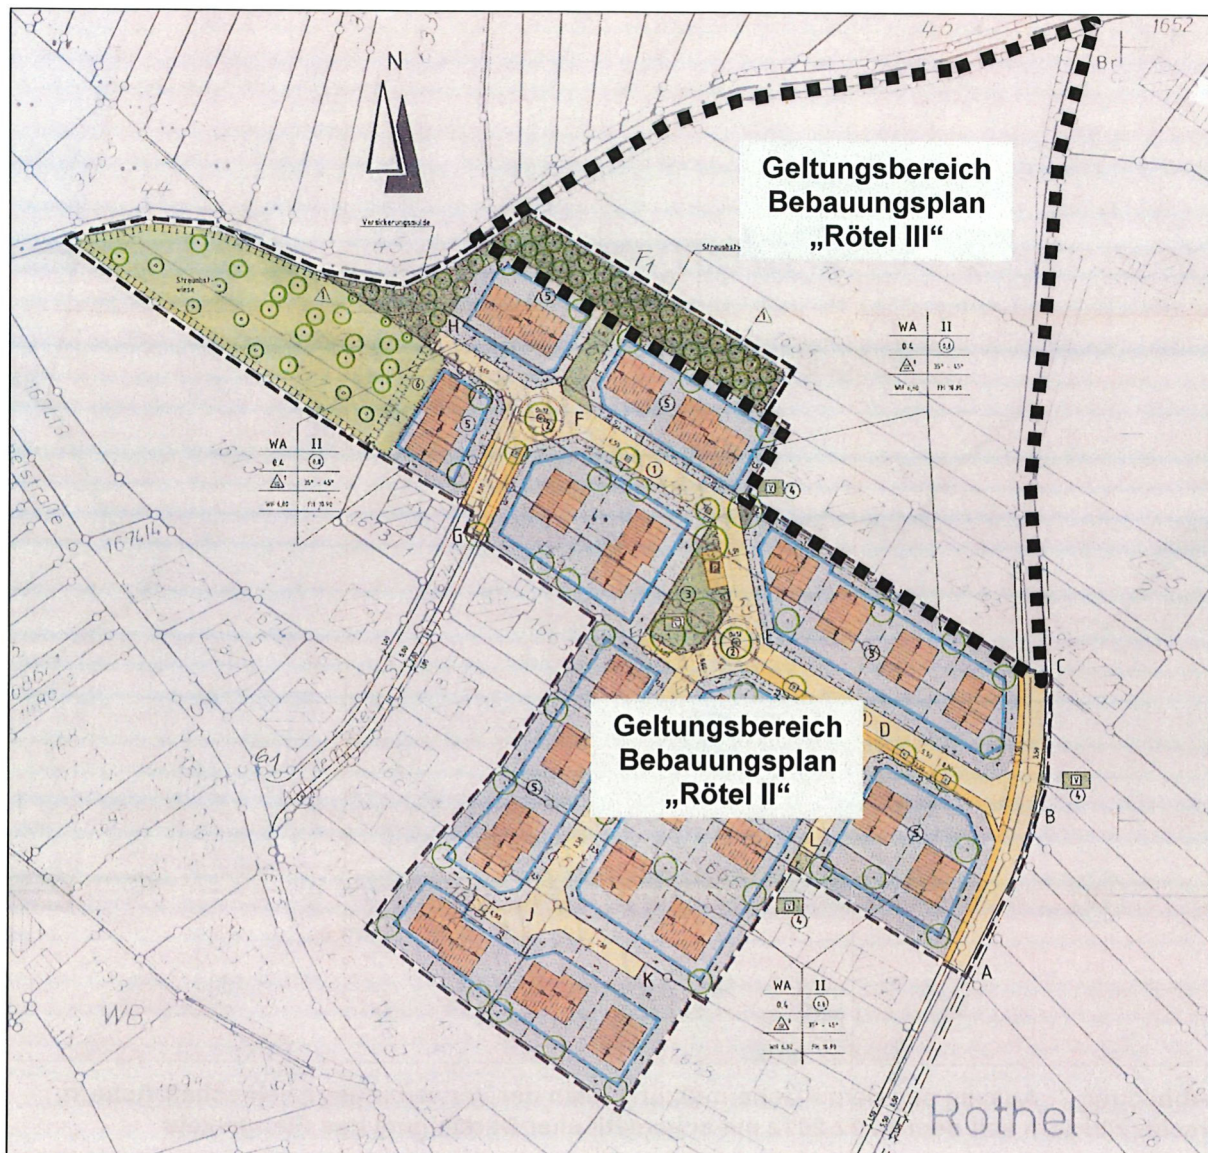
Bebauungsplan „Rötel II“, rechtsverbindlich seit dem 07.03.1997 mit Geltungsbereich Bebauungsplan „Rötel III“ (schematische Darstellung)
